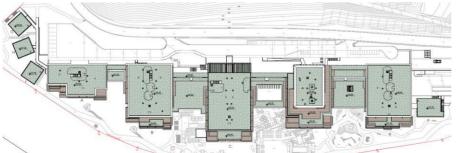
Coberturas ajardinadas previstas no projeto do Aparthotel.
